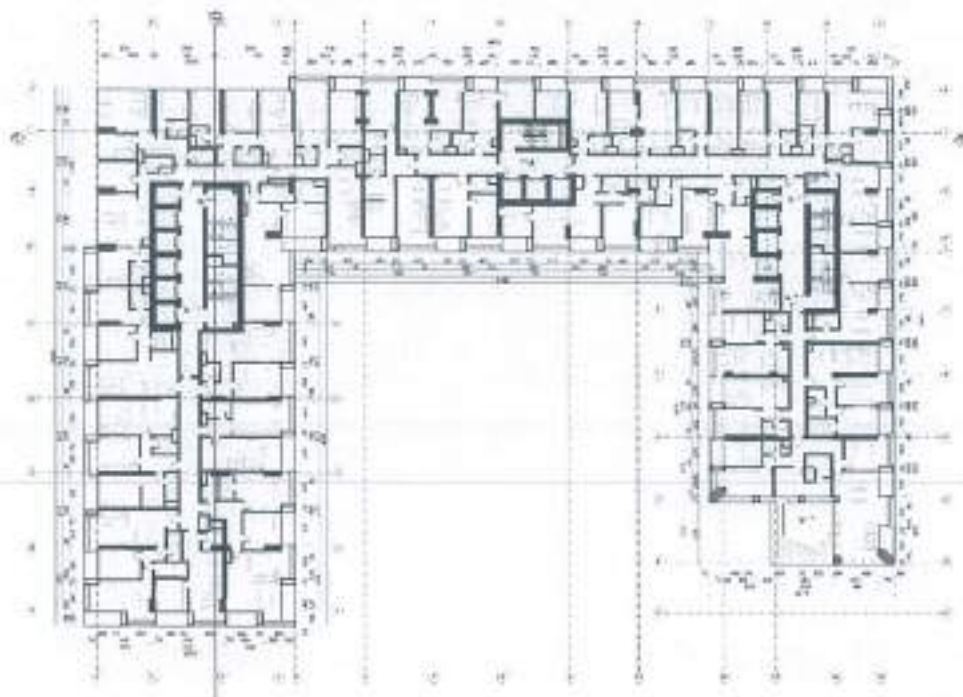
Planimetri e katit +5, në kuotën +19,95
